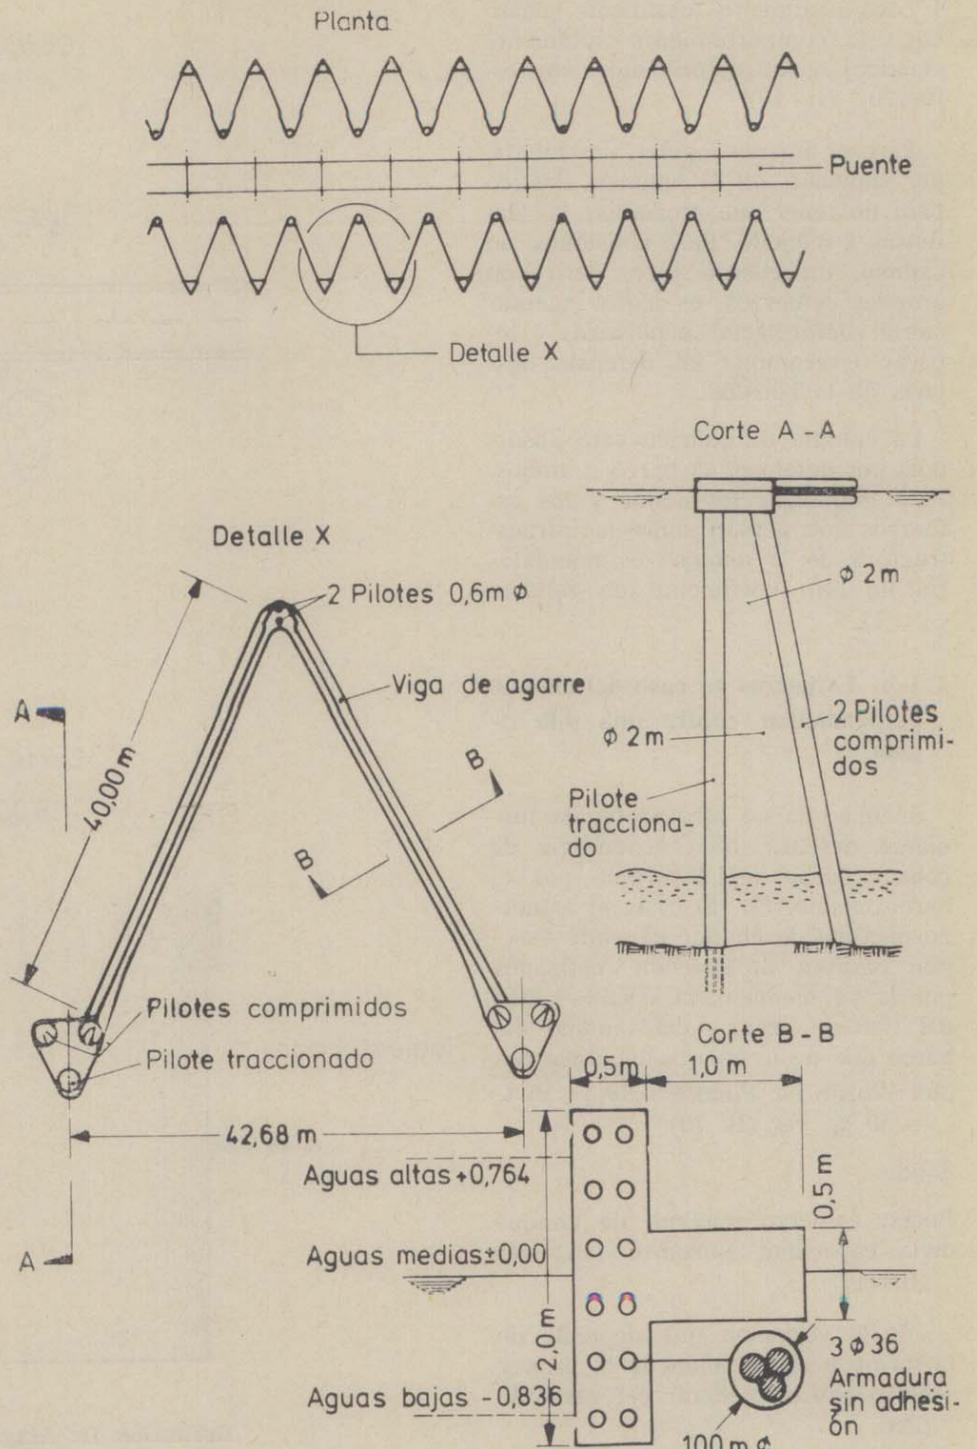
Protección con pilotes inclinados para el puente Tasman en Australia, según (13).
